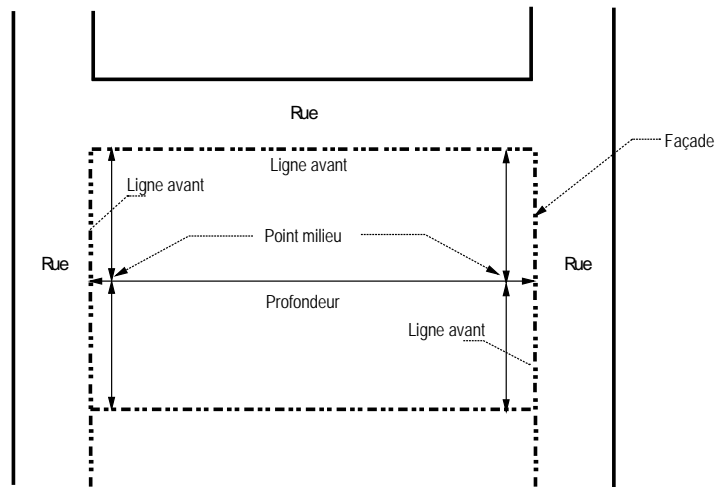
Dimensions d'un emplacement – Emplacement d'angle
